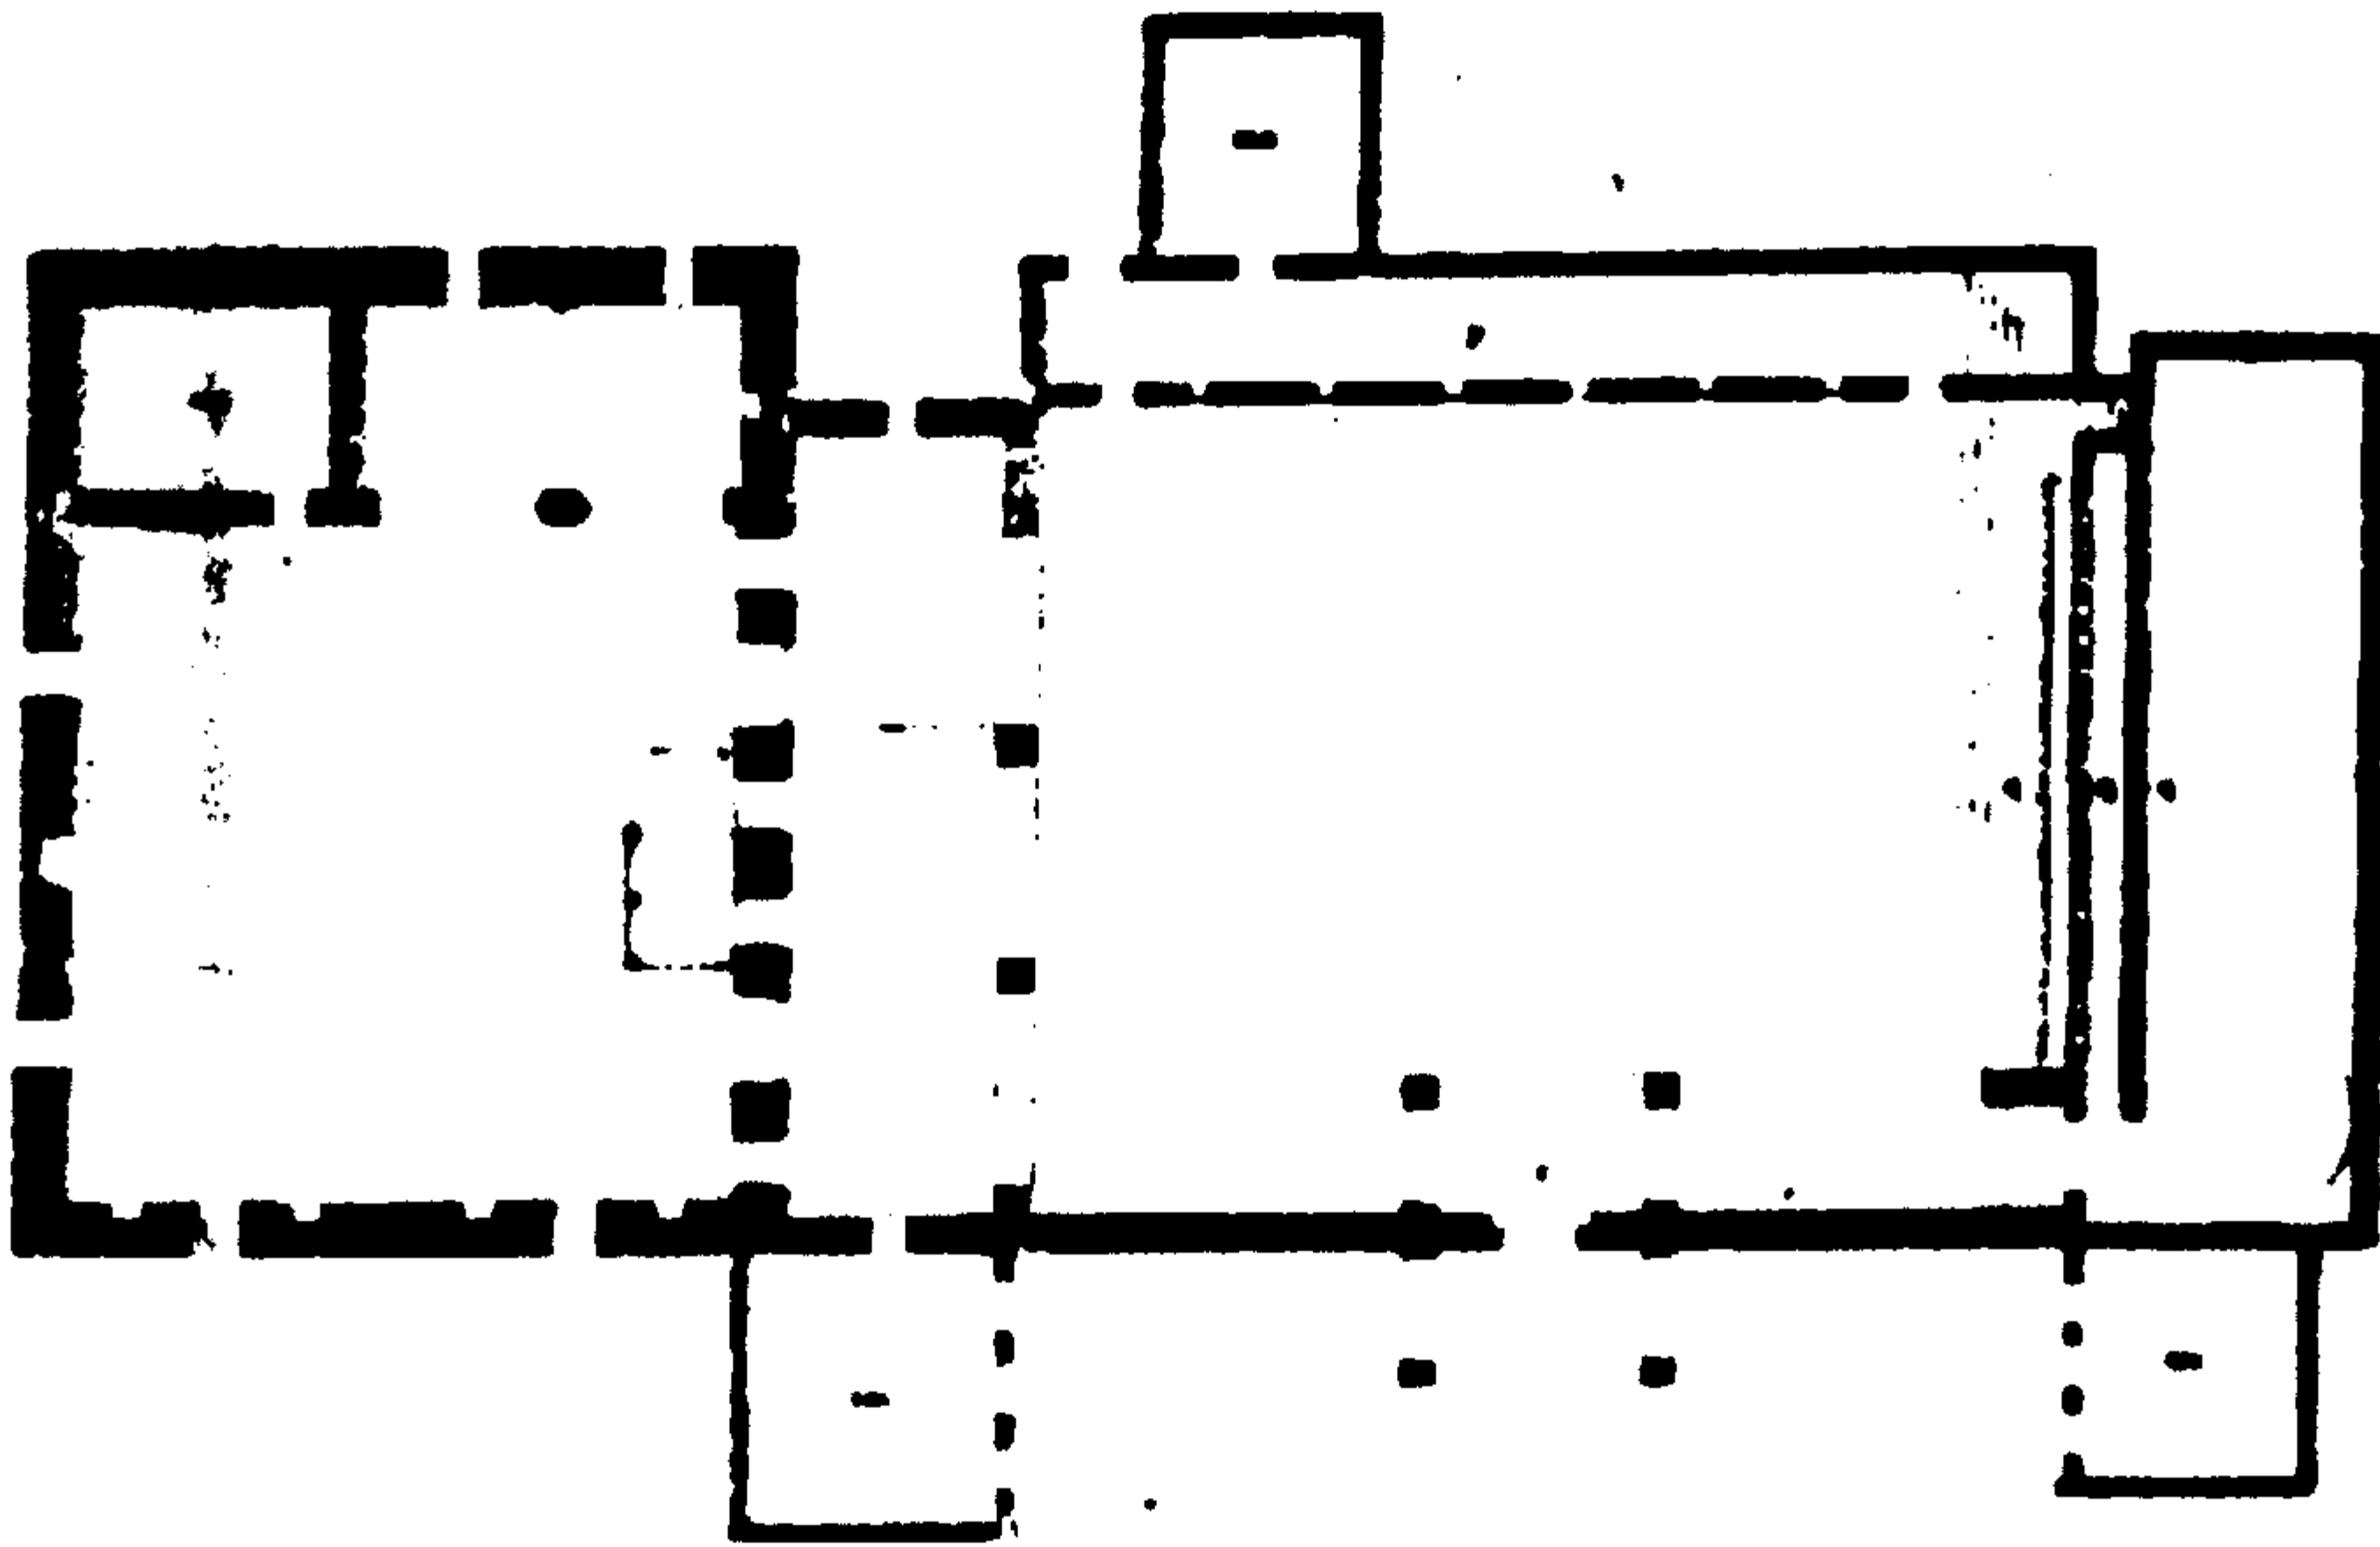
مسقط أفقي لمدرسة وضريح المنصور قلاوون بالقاهرة.
